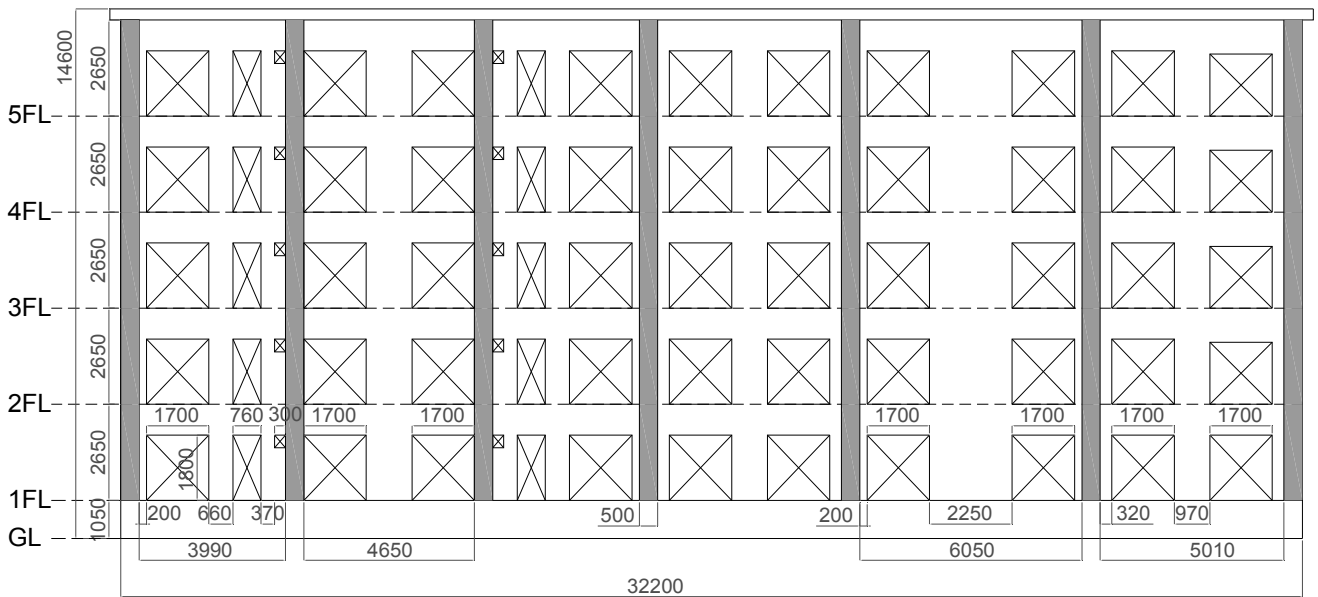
片岸市営住宅 平面図 (単位: mm)
